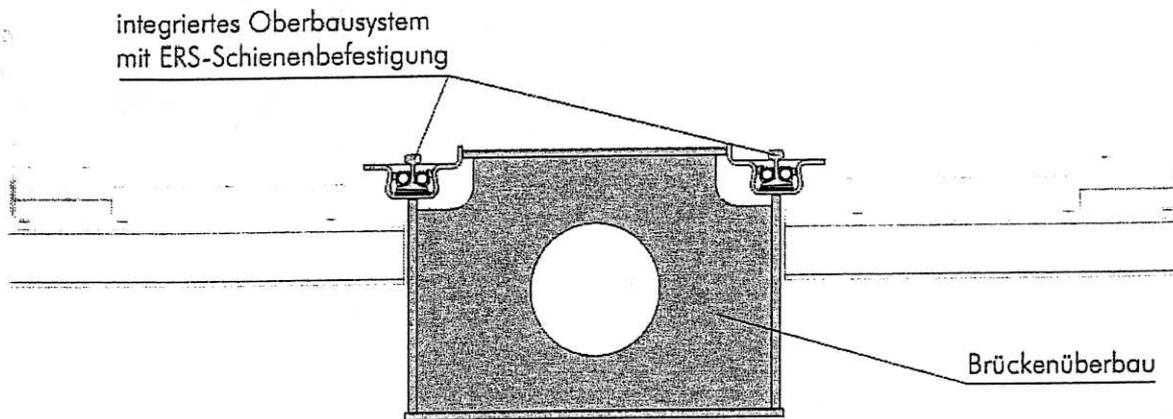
Querschnitt durch ein Brückenelement einer Silent Bridge®
